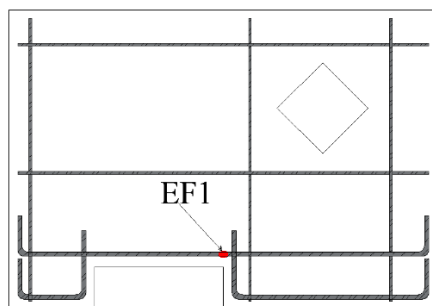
Posição dos extensômetros na armadura longitudinal da Série 2 (Vista frontal)
